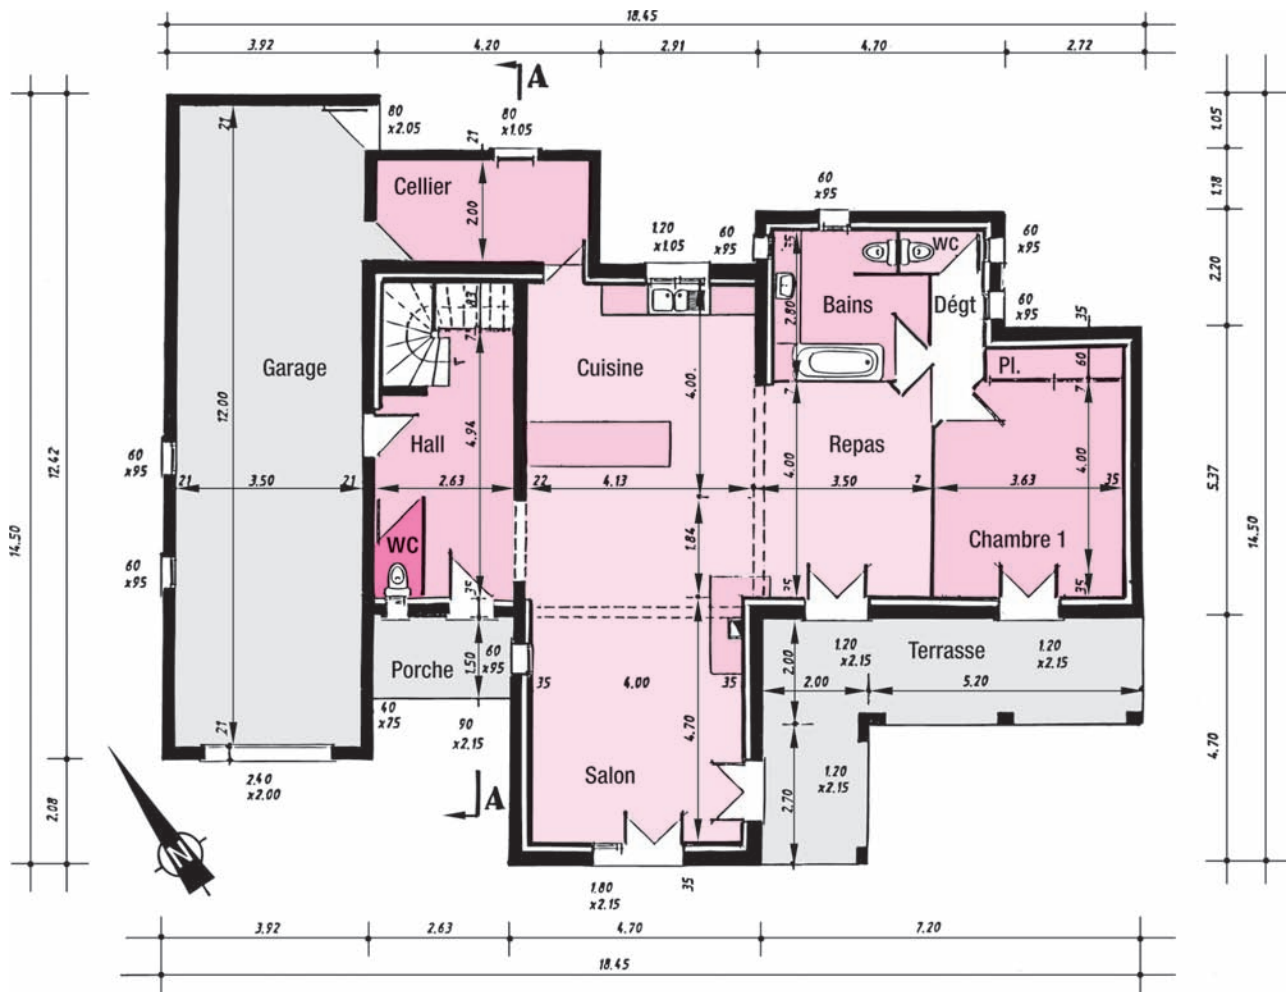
Plan du rez-de-chaussée avec terrasse en L
